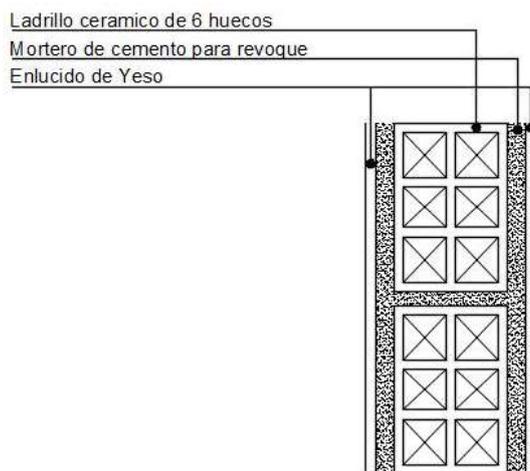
Detalle de partición interior con muro simple sin aislamiento.
